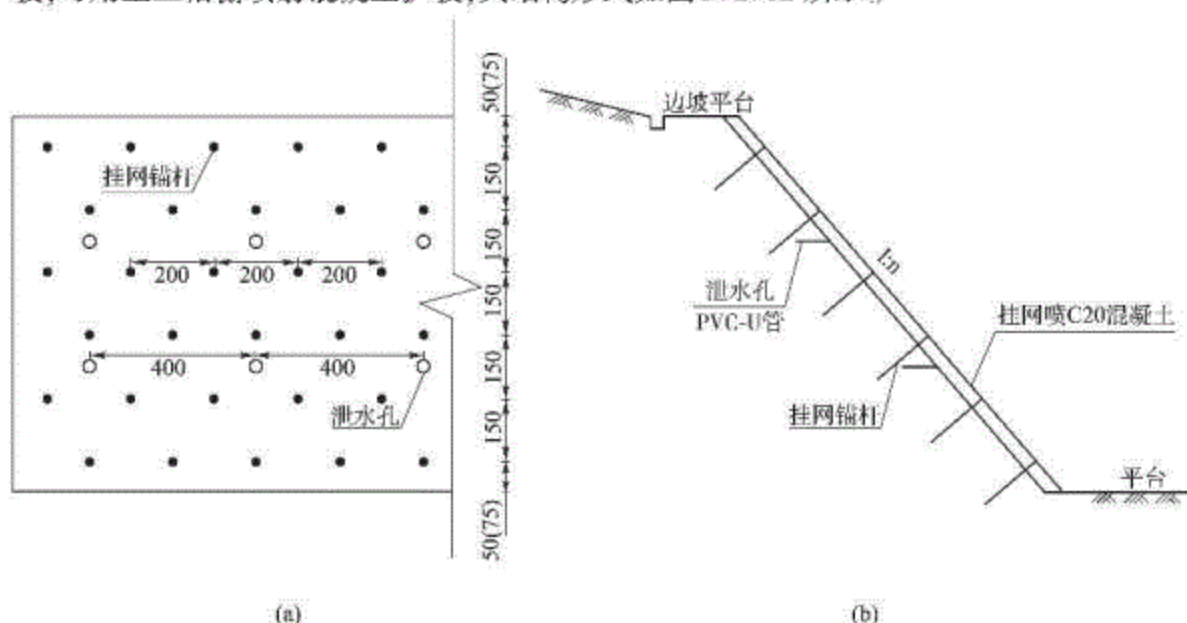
土工格栅喷射混凝土护坡结构形式(尺寸单位:cm)
